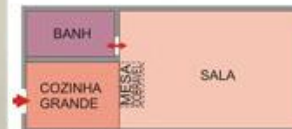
e 11: Proposição de Layout, Ocupação Chiquinha Gonzaga.
